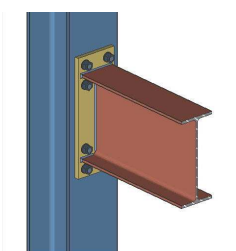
Assemblage boulonné à plaque d'extrémité
